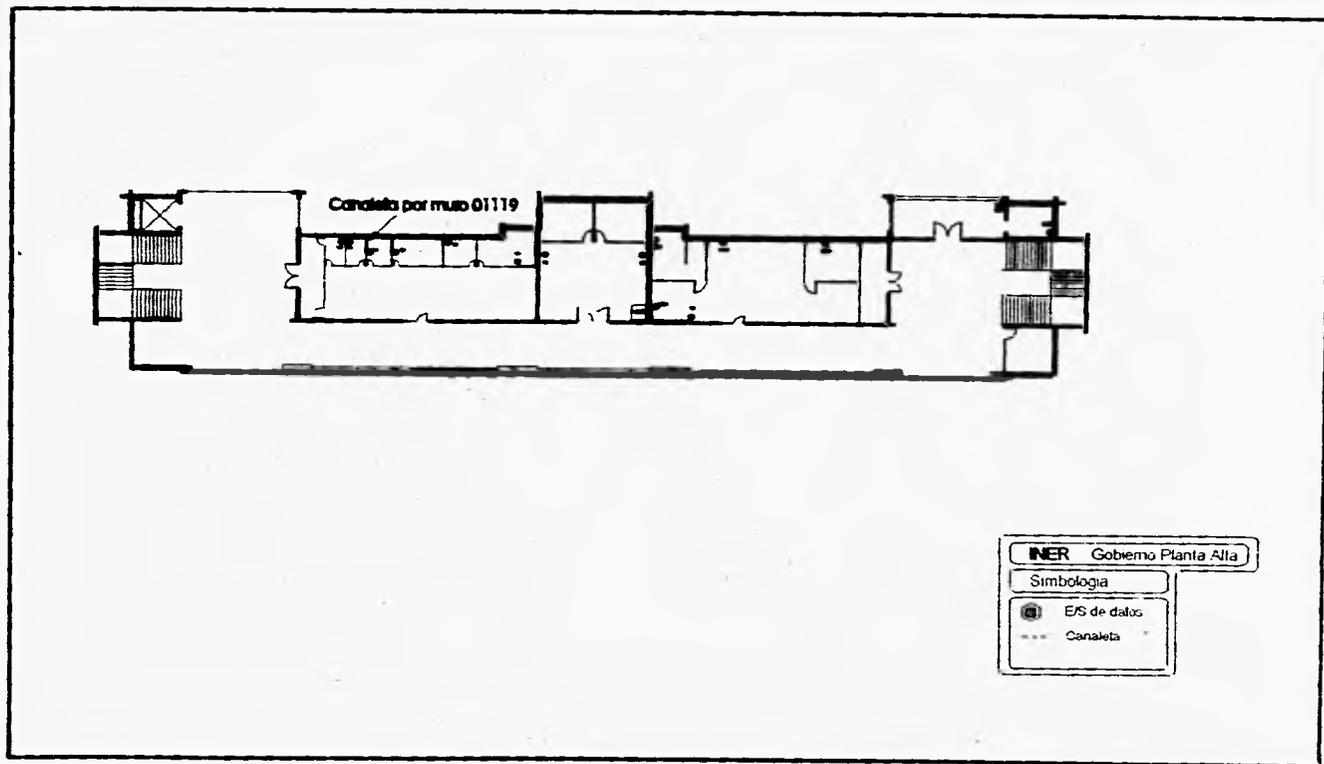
Cableado del Edificio de Gobierno Planta Alta
